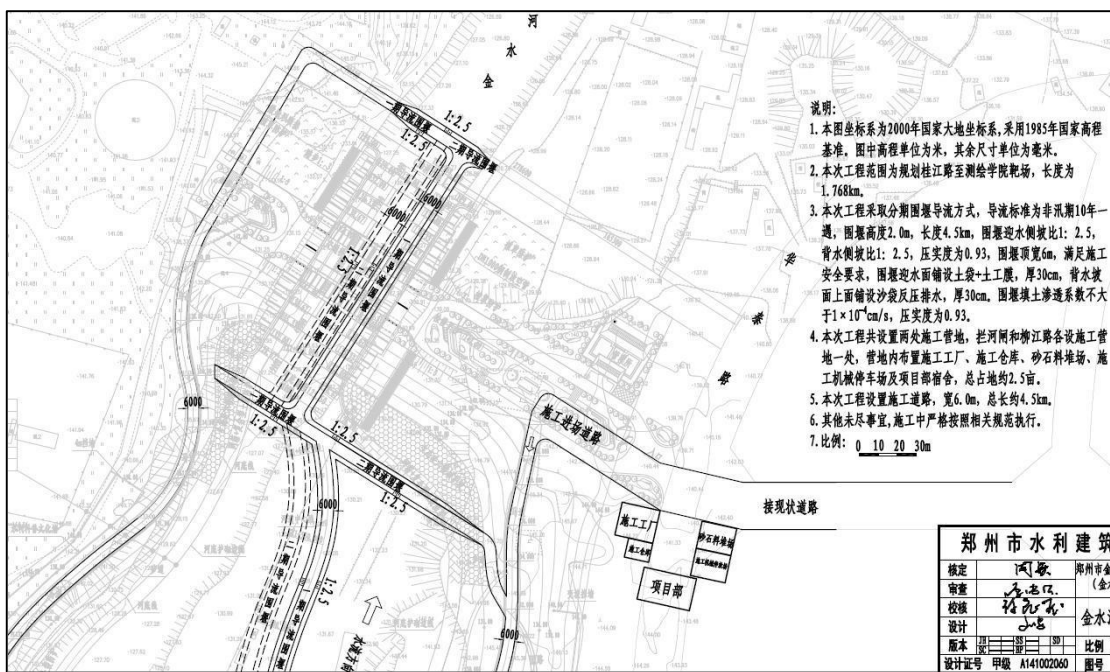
靶场拦河闸施工营地位置及平面布置
